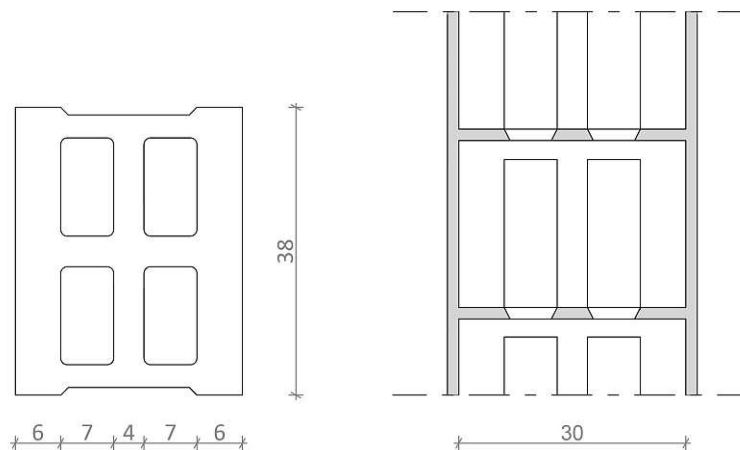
Steingrundriss und Schnitt durch die Wand von in Deutschland genormten Mauerwerk aus Leichtbeton-Hohlblocksteinen (DIN 4152-4154) nach [59]
